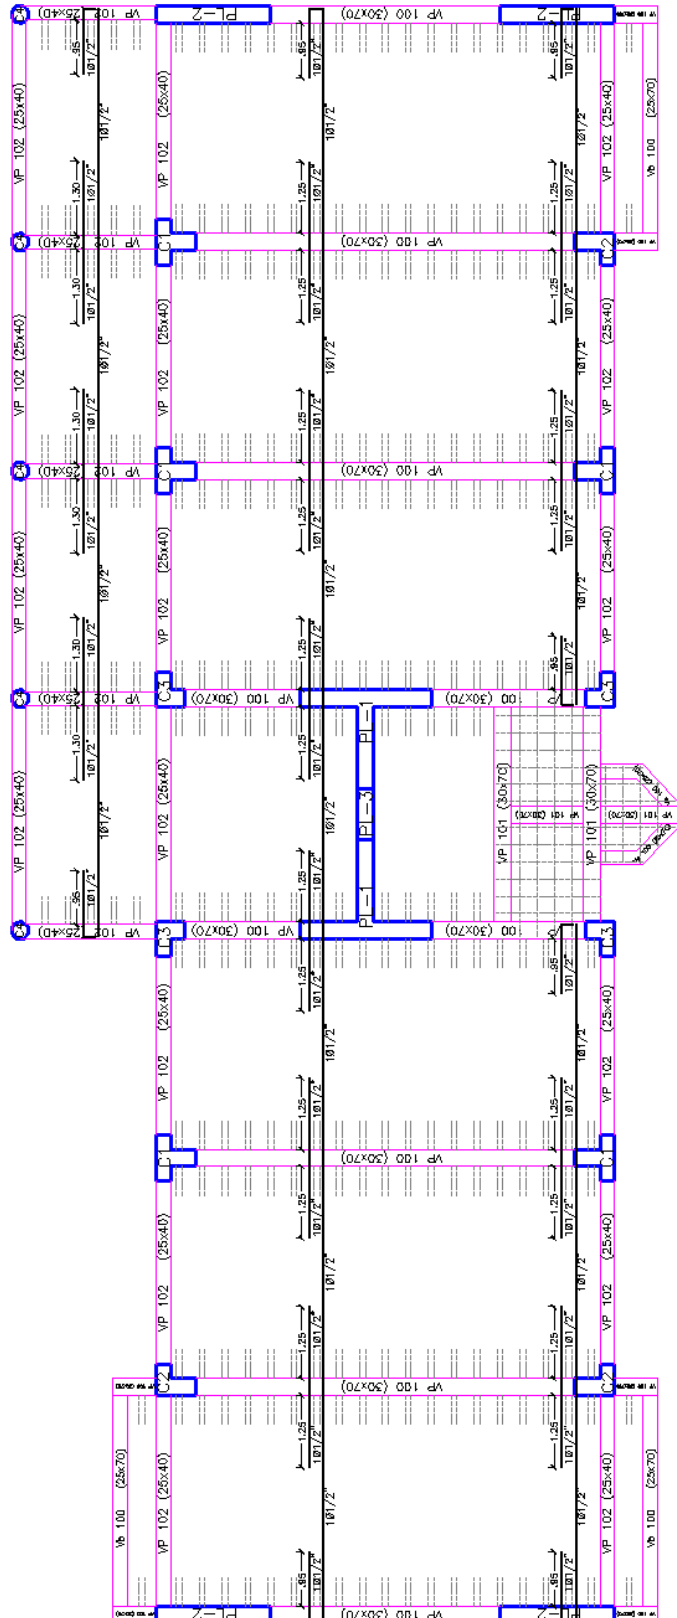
Planta, aligerado 1, NTNT: +3.65.
